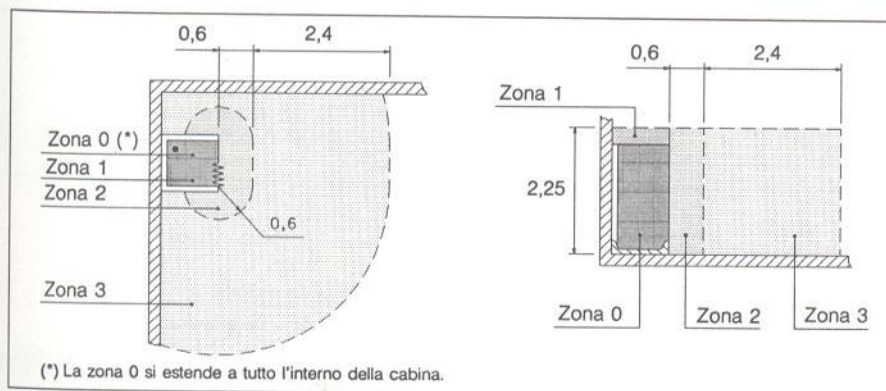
Individuazione delle zone nei locali con docce prefabbricate (quote in metri). La zona 0 si estende a tutto l'interno della cabina.
